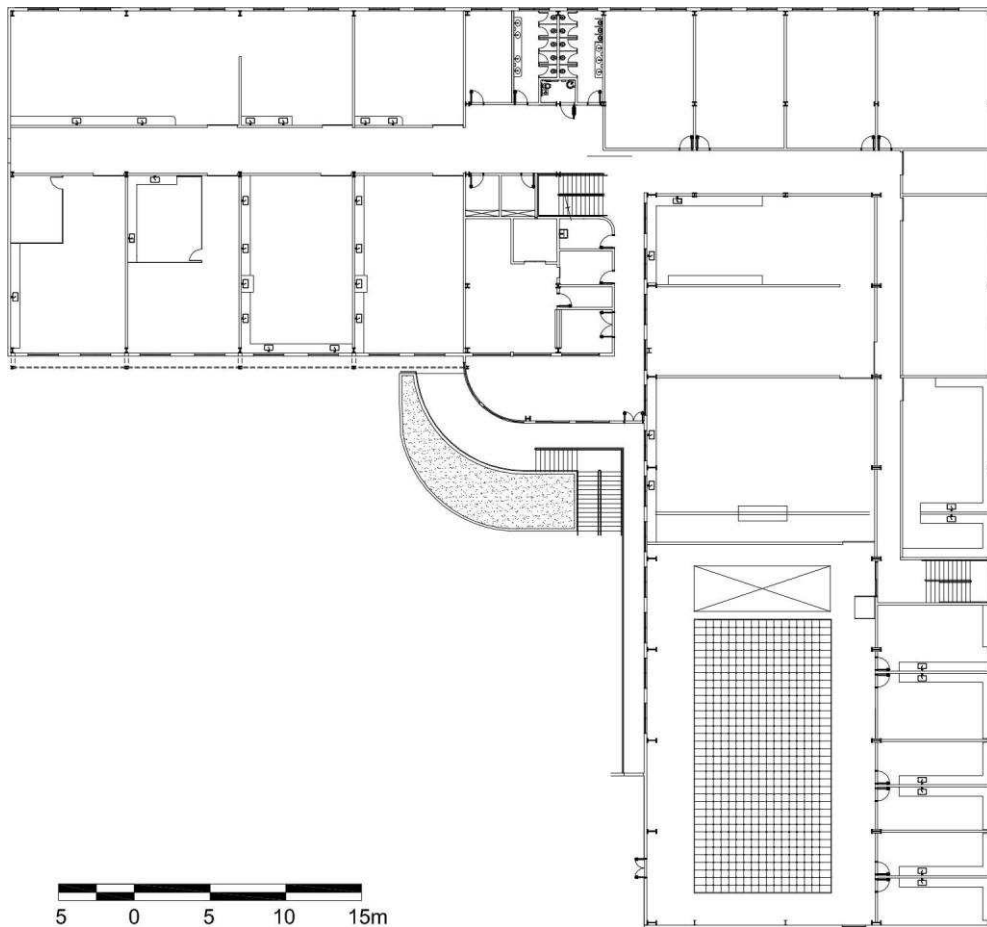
Planta do primeiro pavimento do Edifício LBE.
